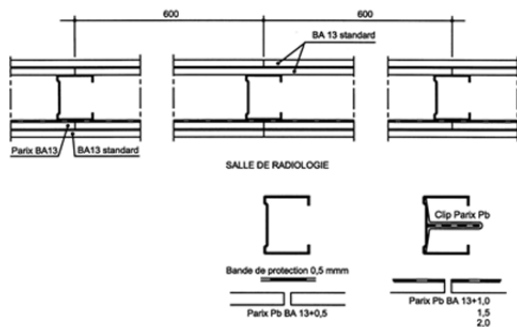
Disposition au droit des joints verticaux pour salles radiologie
